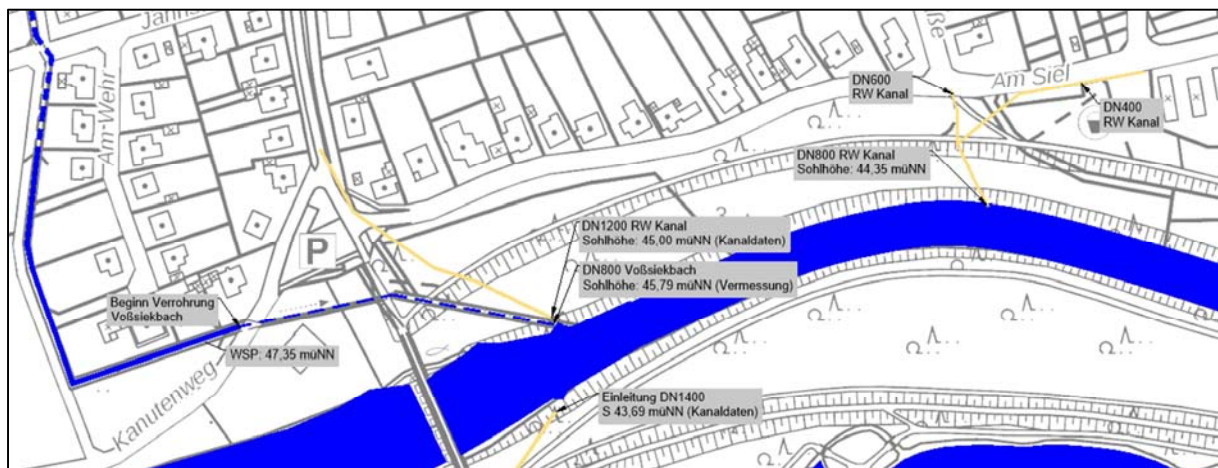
Lageplan Bestand, Einleitung Voßsiekbach
